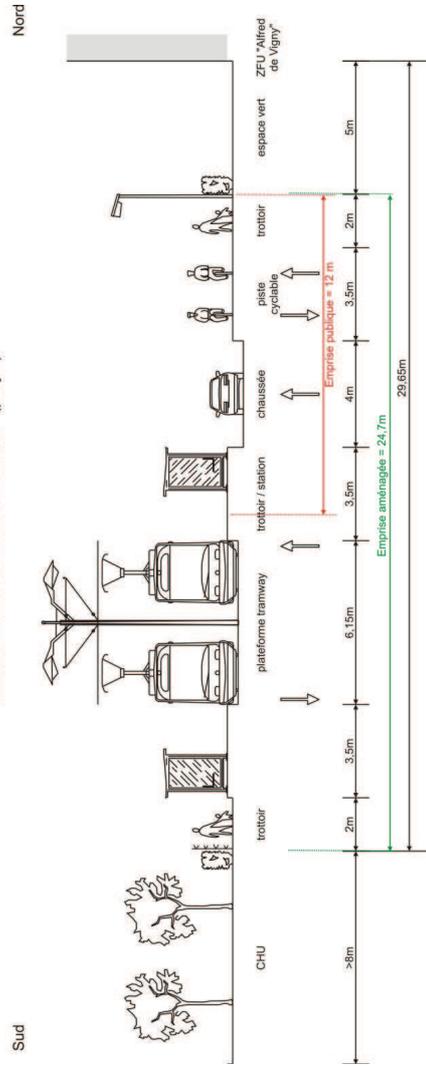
Situation projetée coupe 2 sur l'avenue Molière, station "Molière Est"
